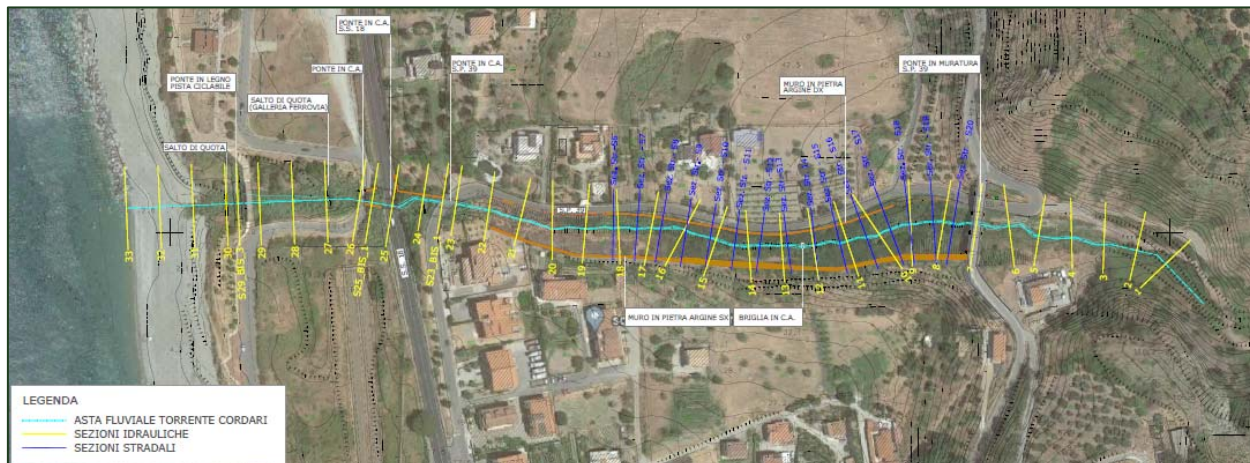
Planimetria con indicazione (in giallo) delle sezioni idrauliche (rif. Tav. 3.1 – Planimetria generale e profilo longitudinale idraulico Stato di Fatto)
